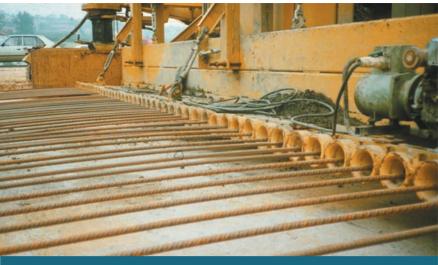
Autovía Oviedo-Pola de Siero: guías en la pavimentadora para posicionamiento de las armaduras longitudinales.
